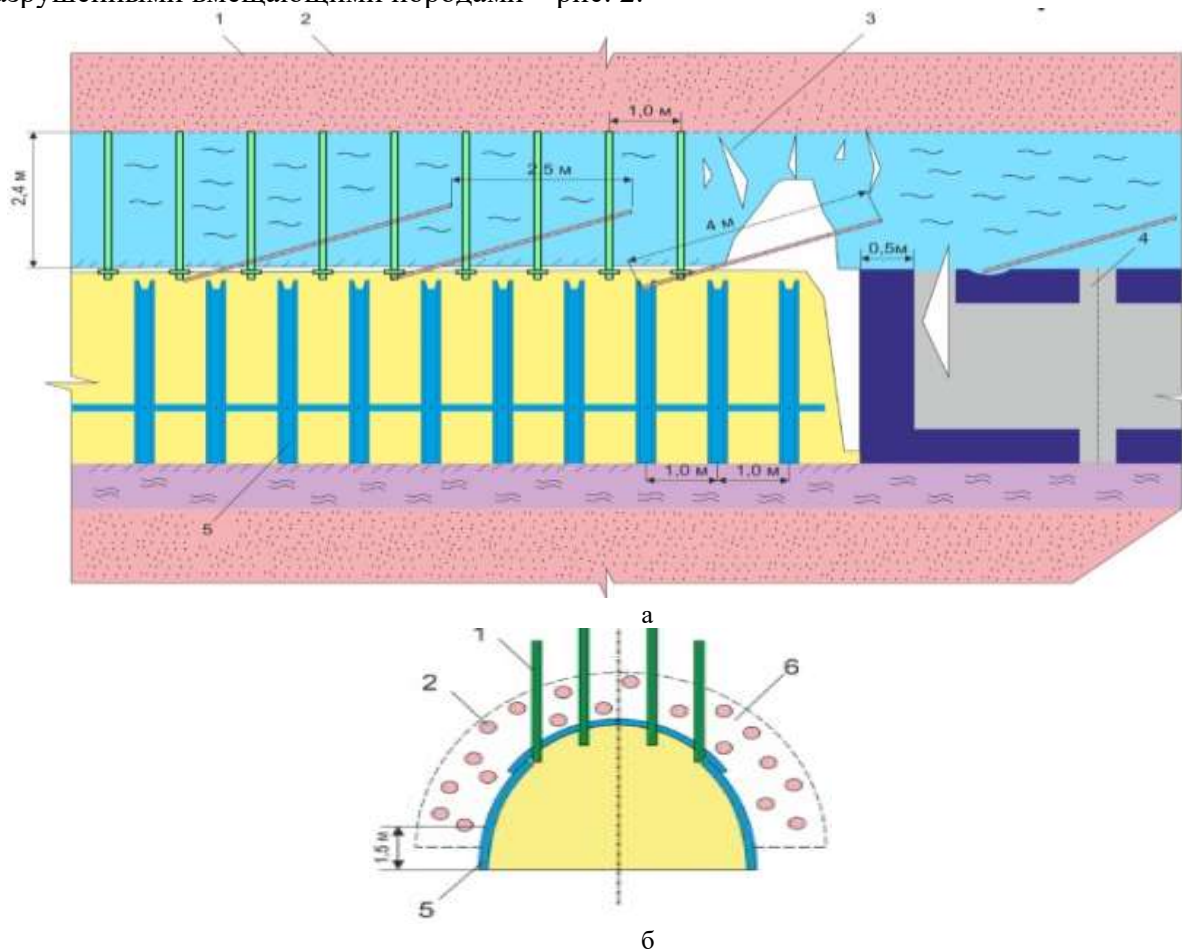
Технологическая схема опережающим кровельным и боковым упрочнением в зоне геологического нарушения
